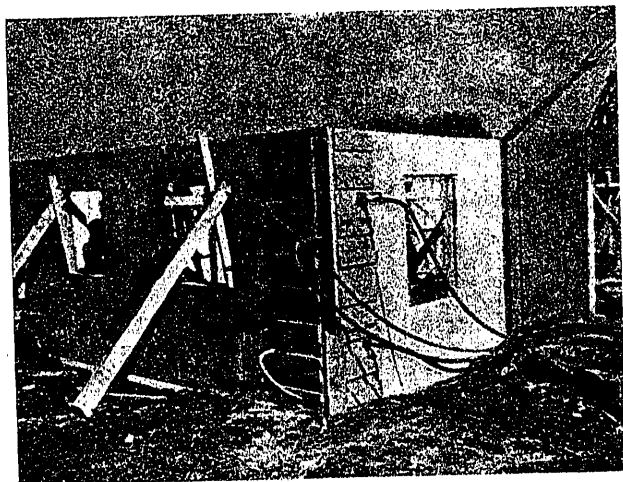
Empalme en ángulo de dos paneles de muro.
